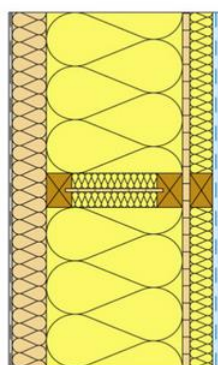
Konstrukce Akastav s I stojnou [woodsystem]
